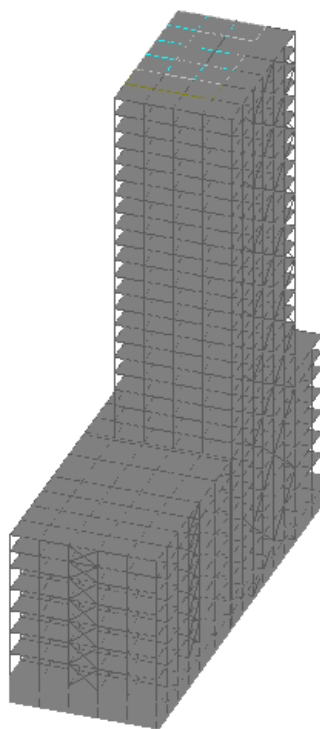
Расчетная схема каркаса варианта № 2
